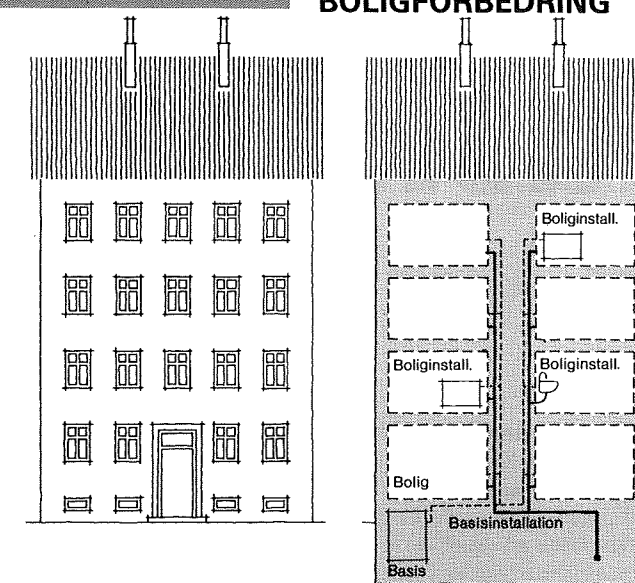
De installationer, som fører frem til de enkelte boliger benævnes: Basisinstallationer. Installationer i boligen, som tilsluttes basisinstallationen, kaldes boliginstallationer.
